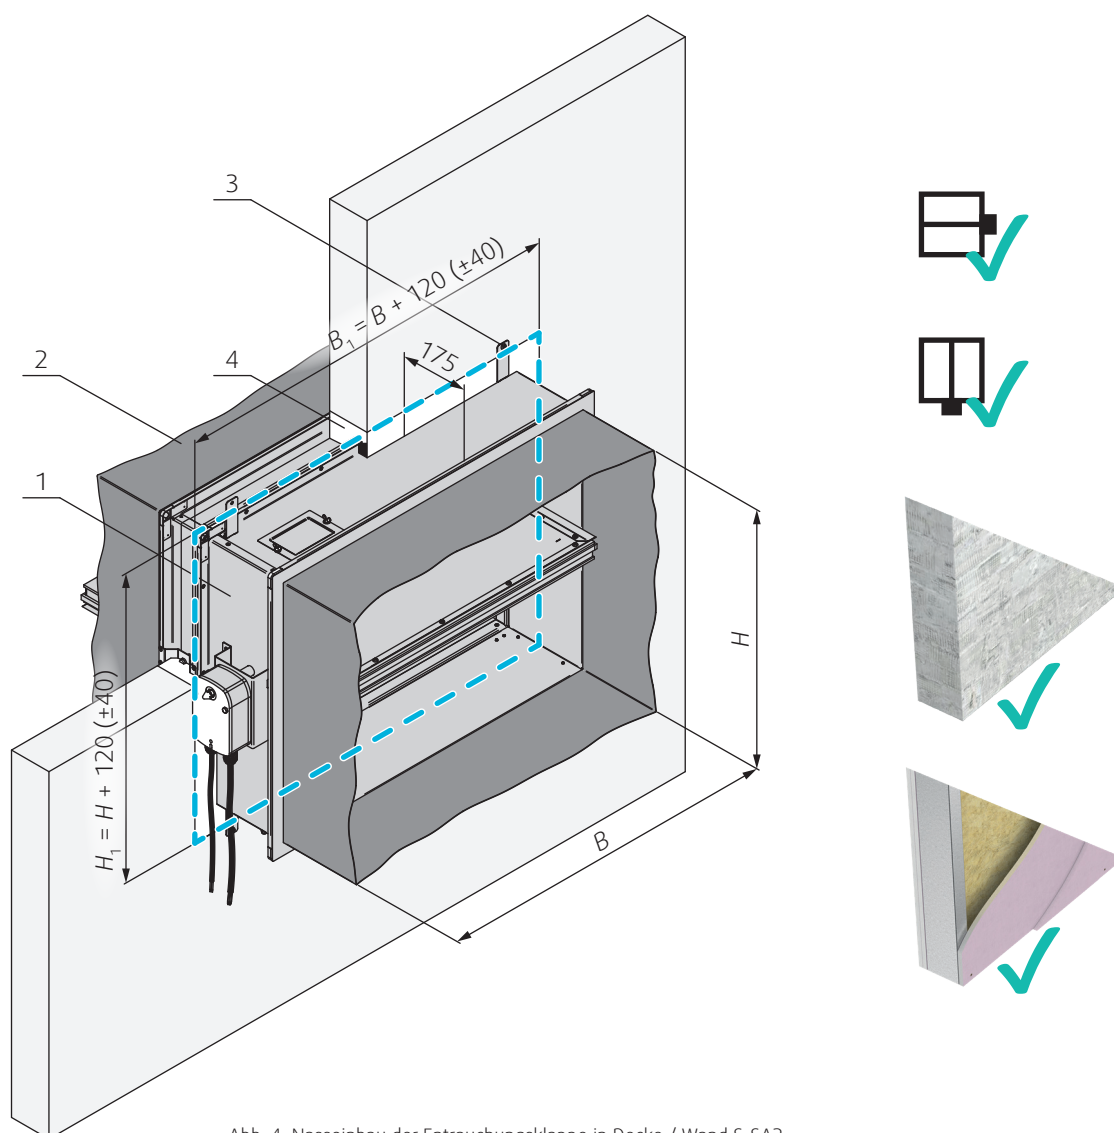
Nasseinbau der Entrauchungsklappe in Decke / Wand S-SA2
